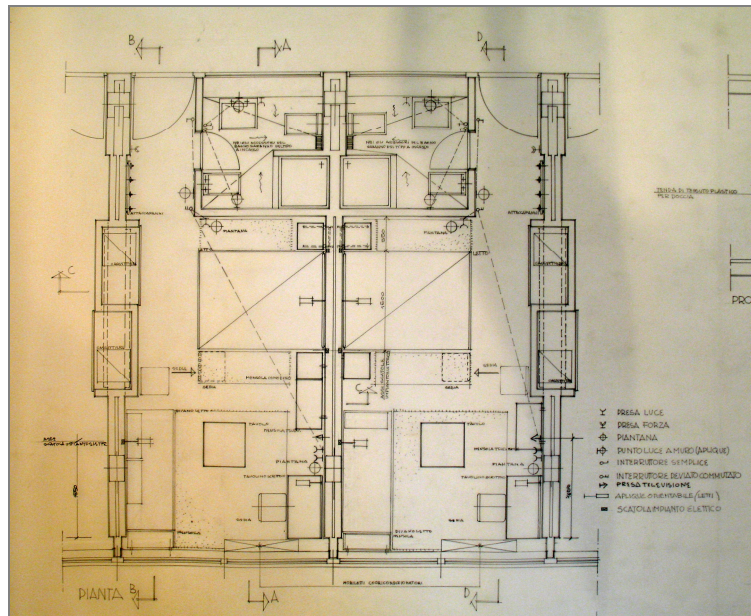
camera tipo – arredo e impianto elettrico (fonte CSAC – stralcio tav. 33, archivio n. 276-1)
